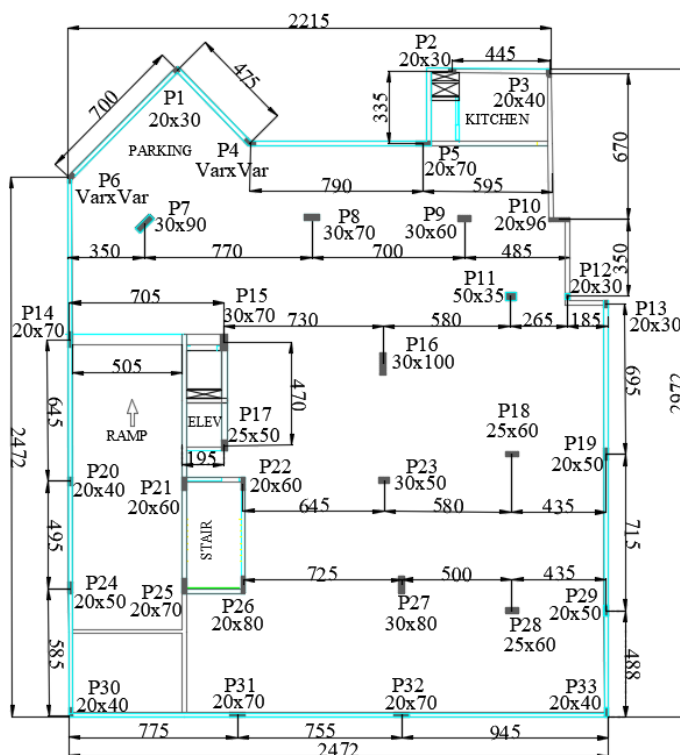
Planta baixa do terceiro pavimento – cotas em cm
